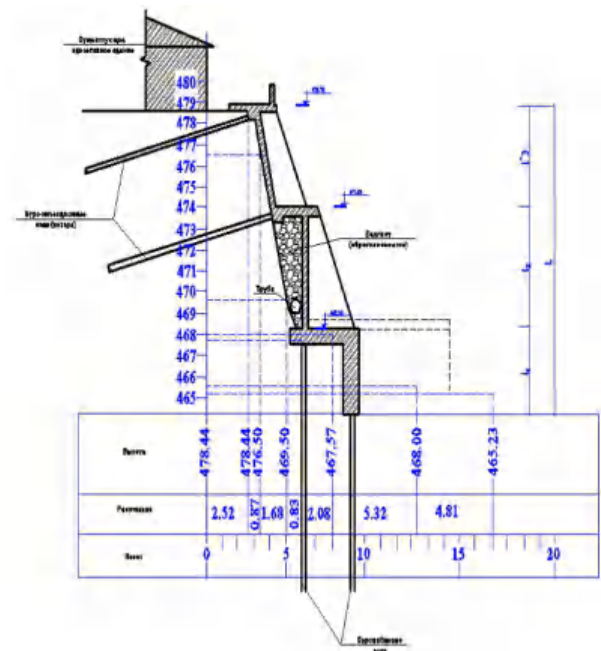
Поперечный разрез одевающих (прижимных) подпорных стен на свайном фундаменте. Вариант III. / Cross section of clamping retaining walls. Option III.
